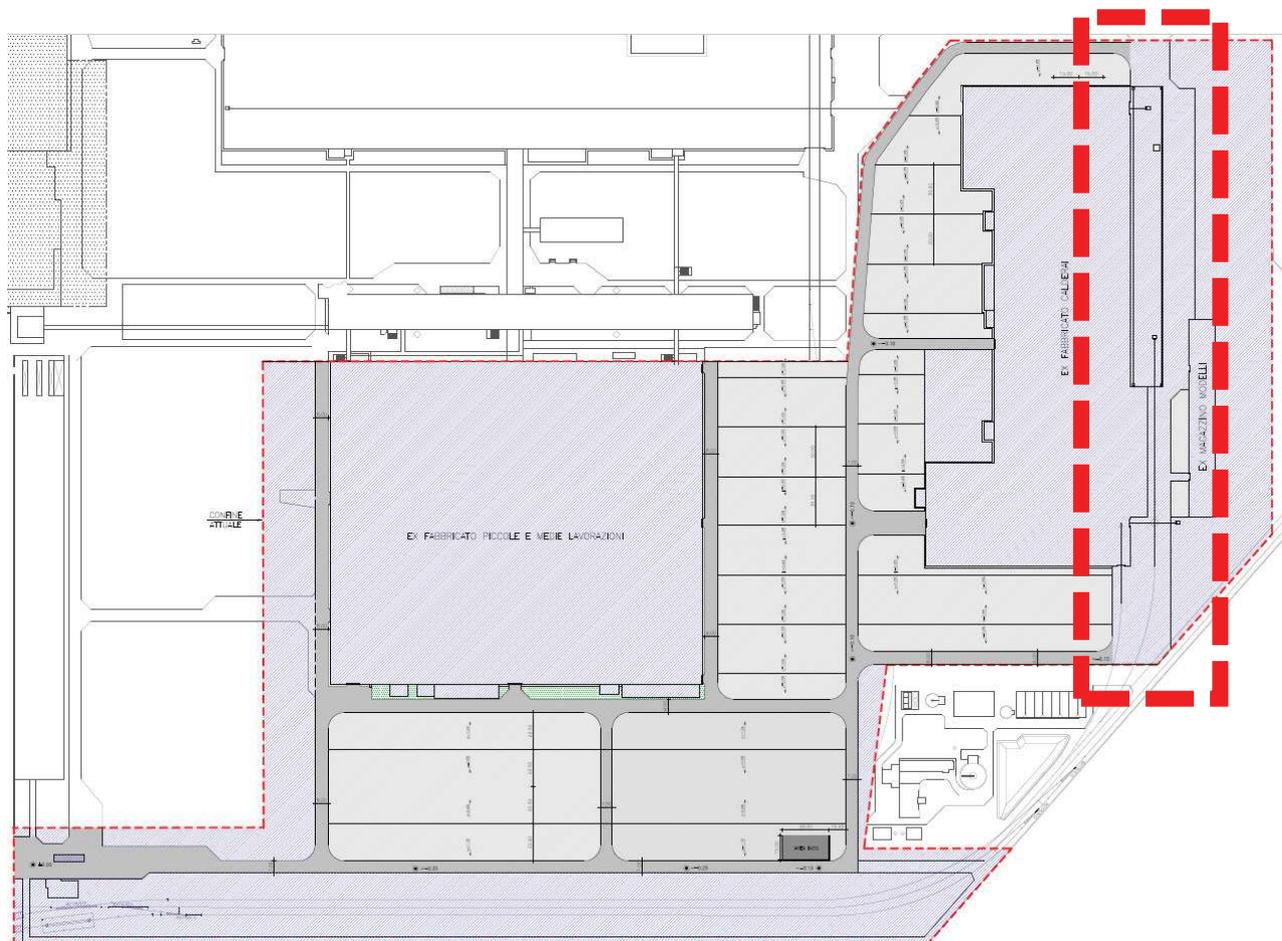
Planimetria dell’area in oggetto dell’intervento con evidenziato in rosso il piazzale
